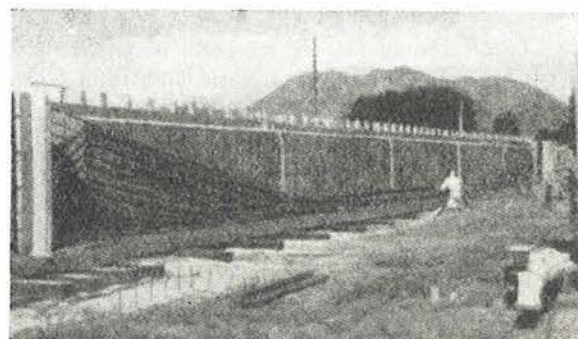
Viga postesada de 108 pies. Montaje de los cables en vainados.
